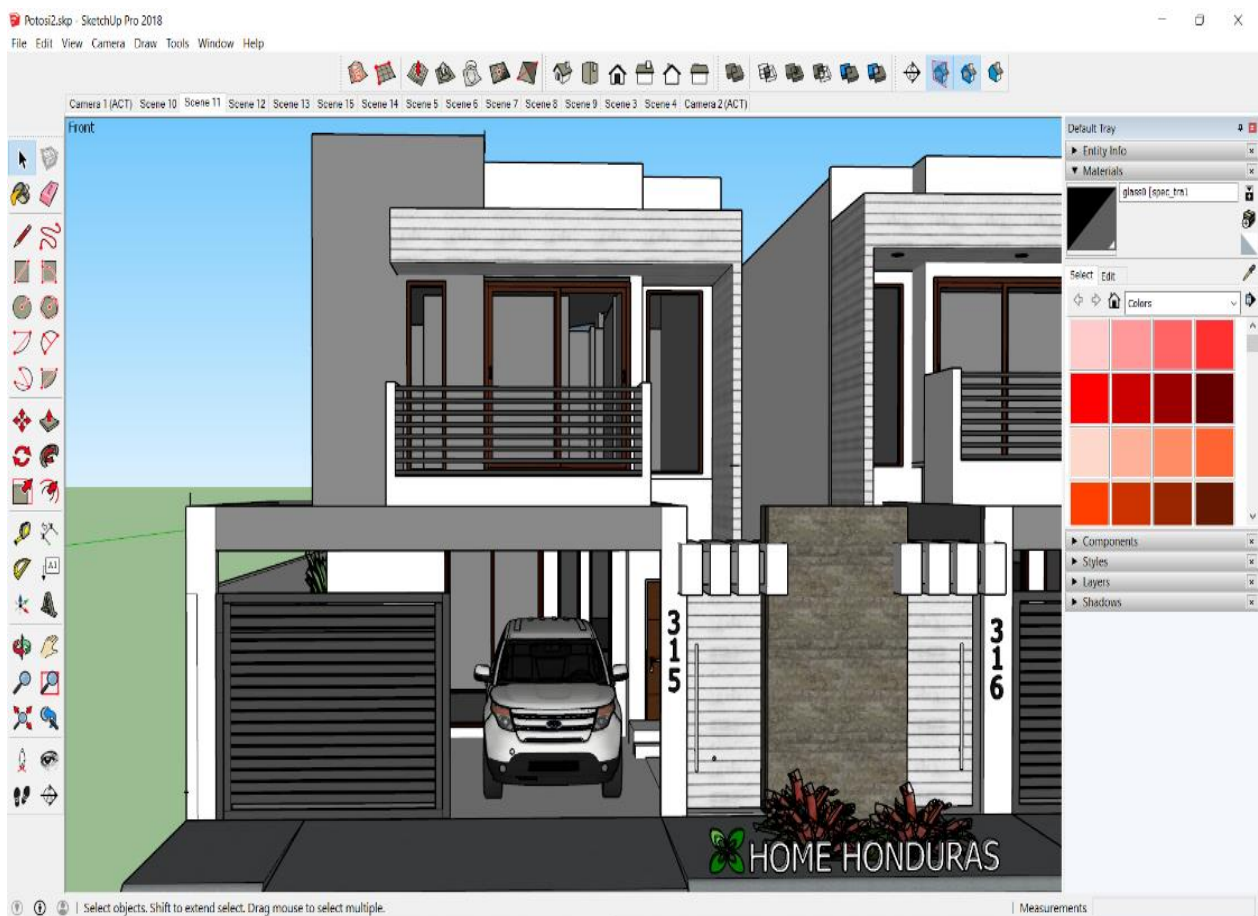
Desarrollo de Variantes Townhouse Potosí
